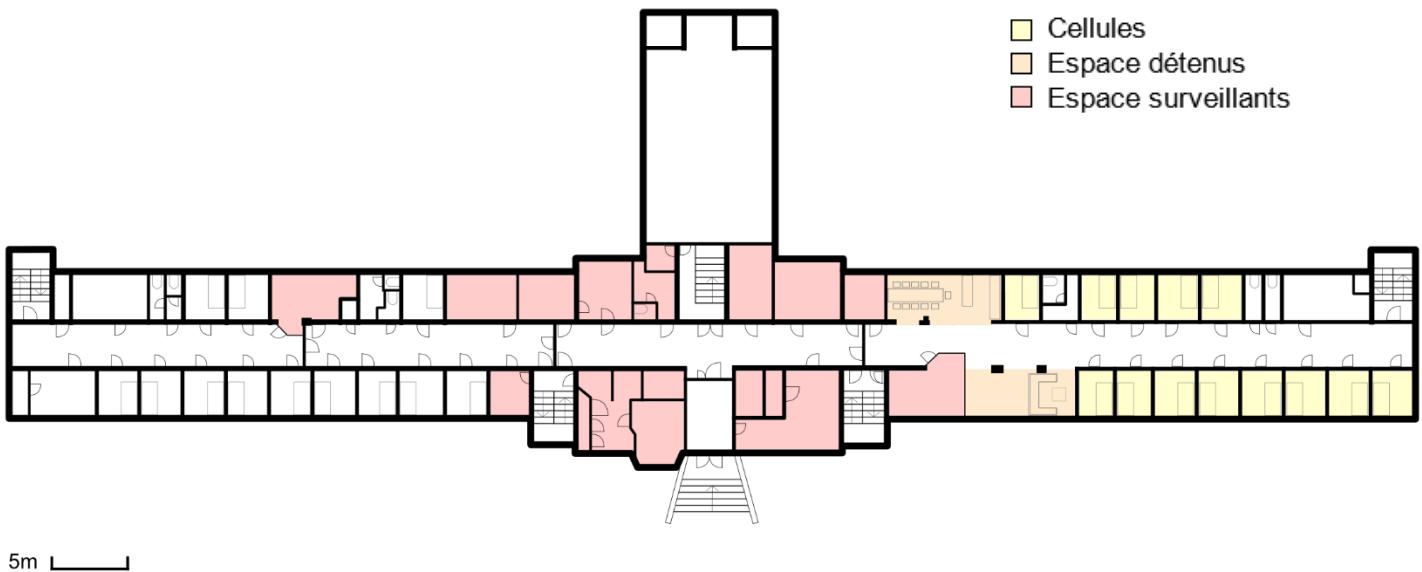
Plan du 1^{er} étage du bâtiment 4a
